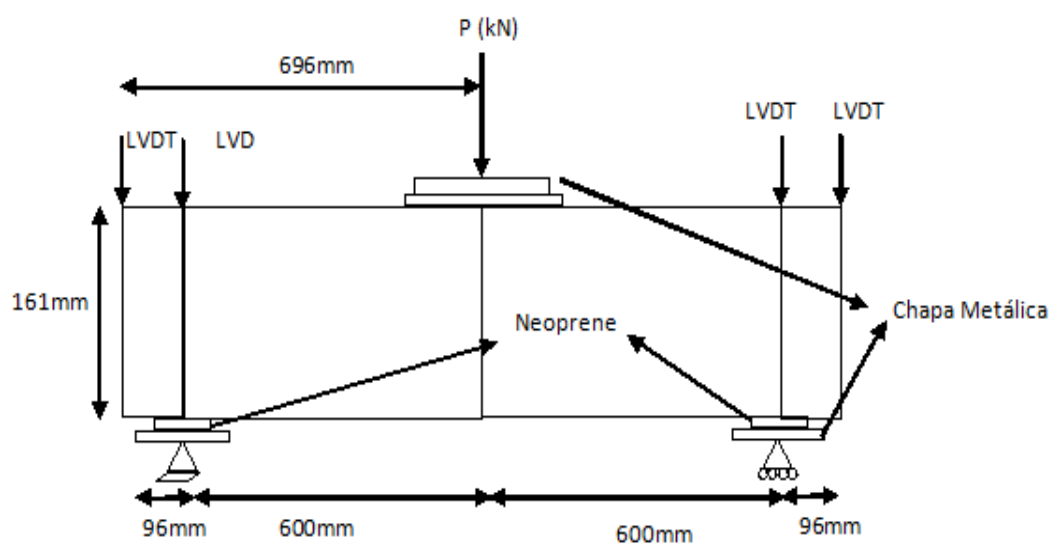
Detalhes da montagem e dimensões do dormente D.P.1.1.E.F.1.C.5-1.
